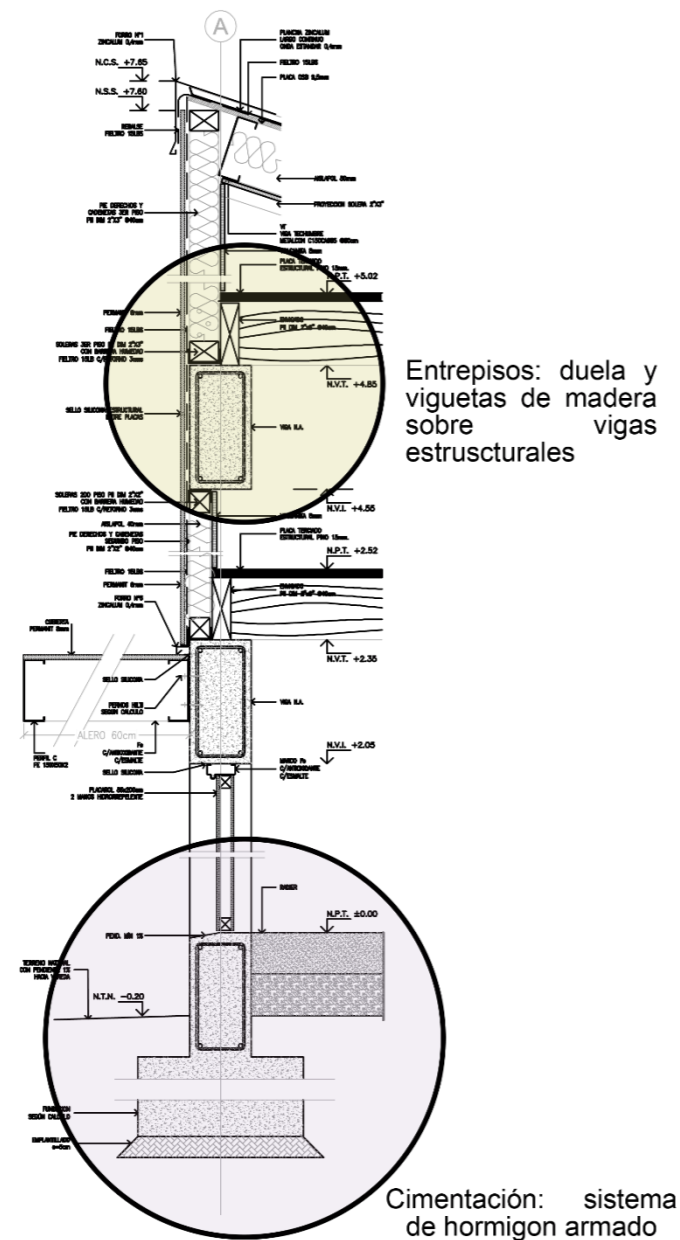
Detalle constructivo del proyecto habitacional Lo Barnechea
